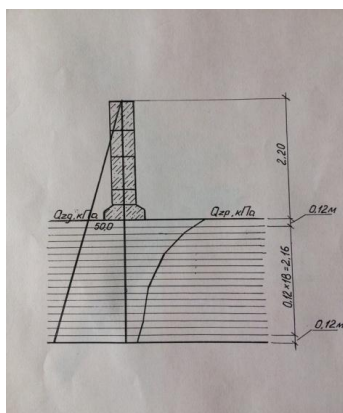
Схема осадки ленточного фундамента под внешние стены после реконструкции жилого дома.
